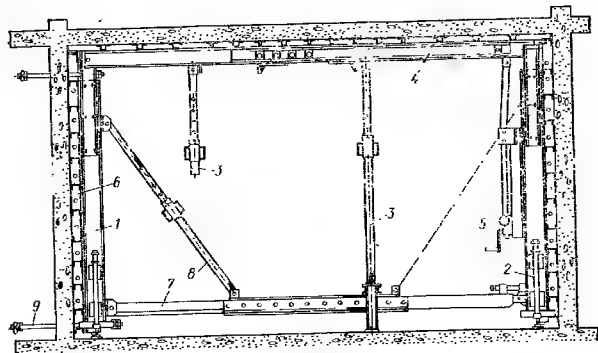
Опалубка фирмы «Батиметалл»:
